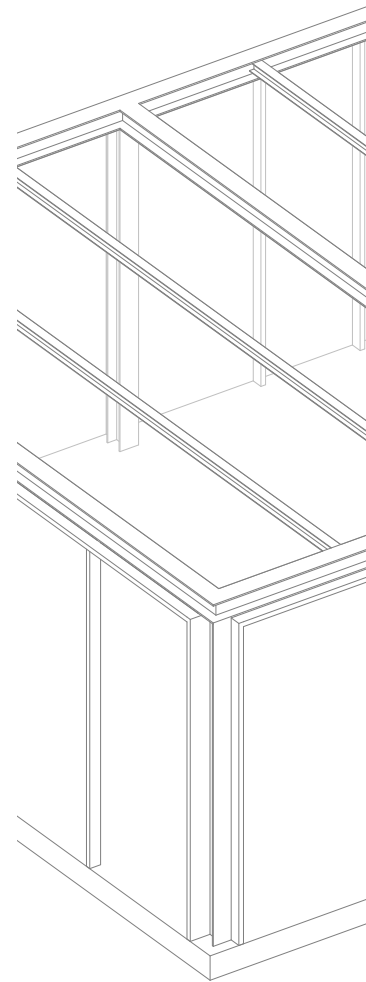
Philip Johnson, Johnson House/Glass House, Connecticut, 1949, Axonometrie Tragwerk
